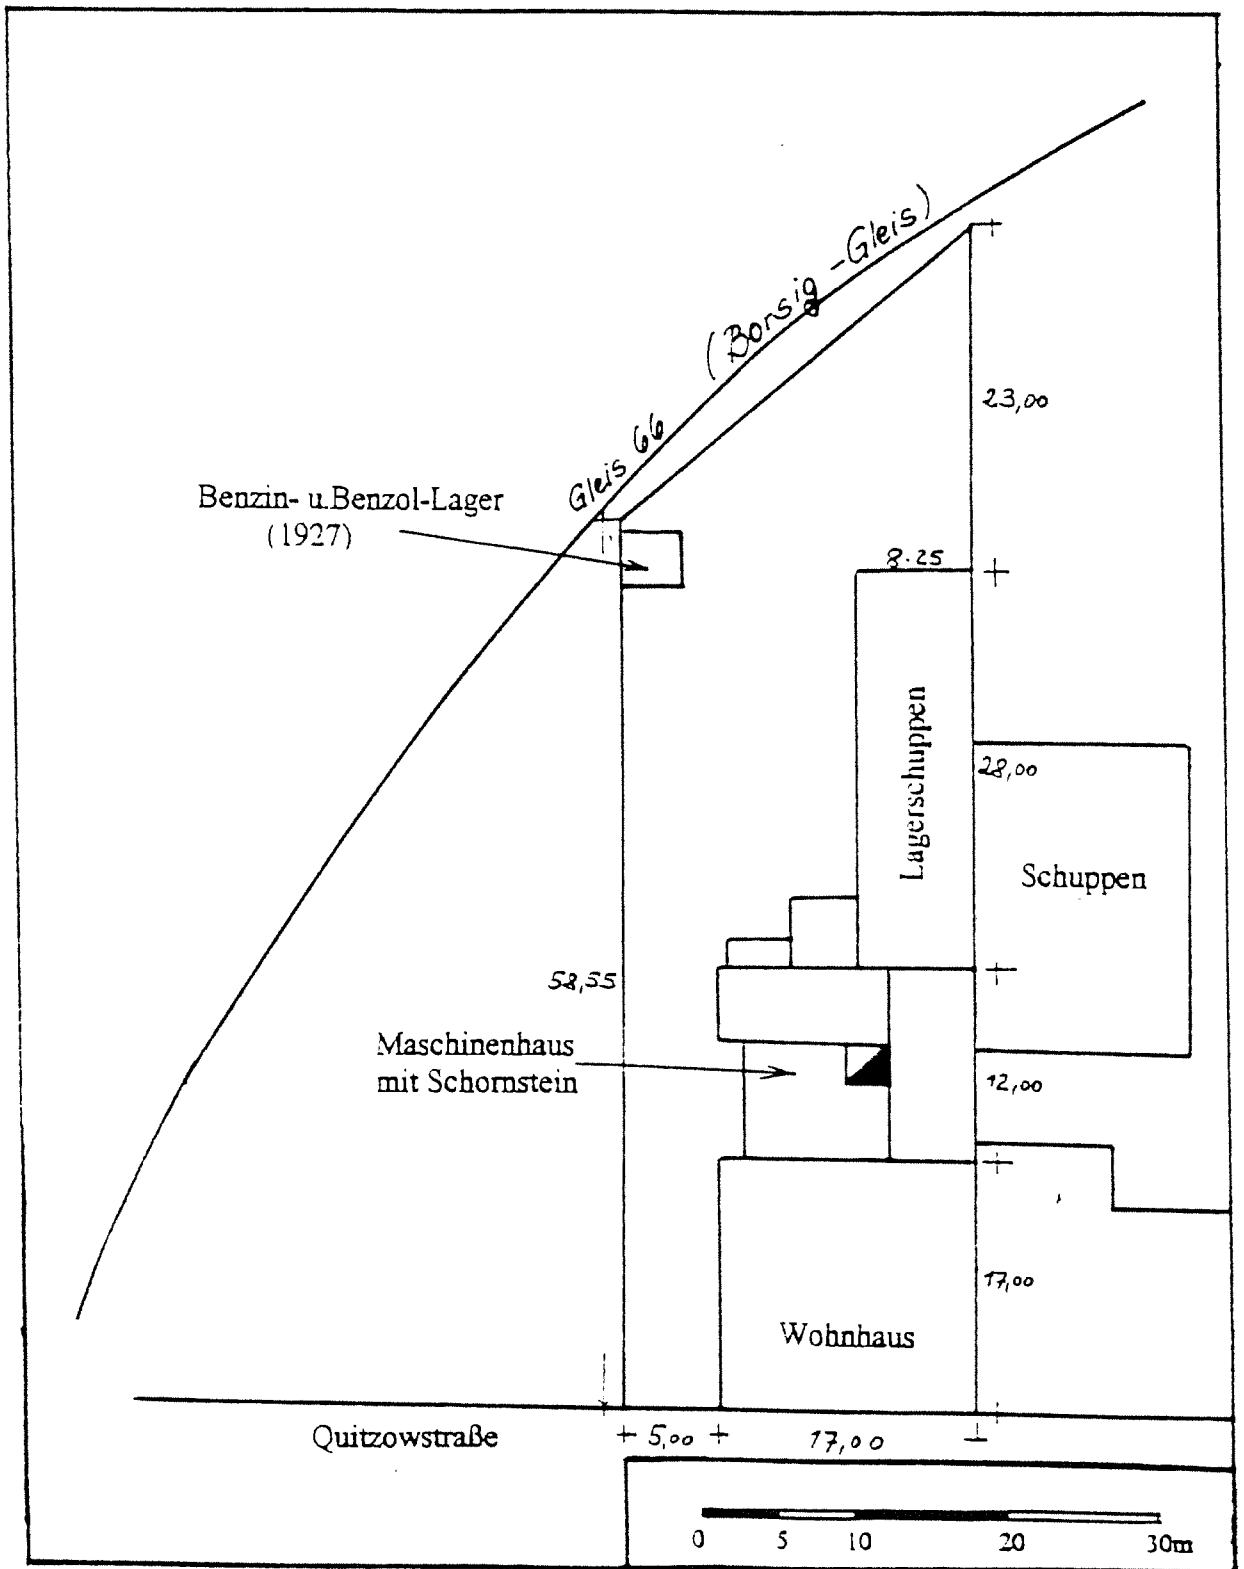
b: Verdachtsfläche 16 - Bebauungssituation 1901 (Quitzwstraße 80-82)
